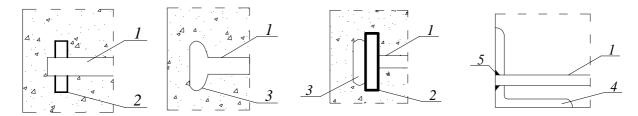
Примеры анкеровки продольного стержня при помощи специальных устройств: 1- стержень; 2- шайба; 3- высаженная головка; 4- уголок; 5- сварка
